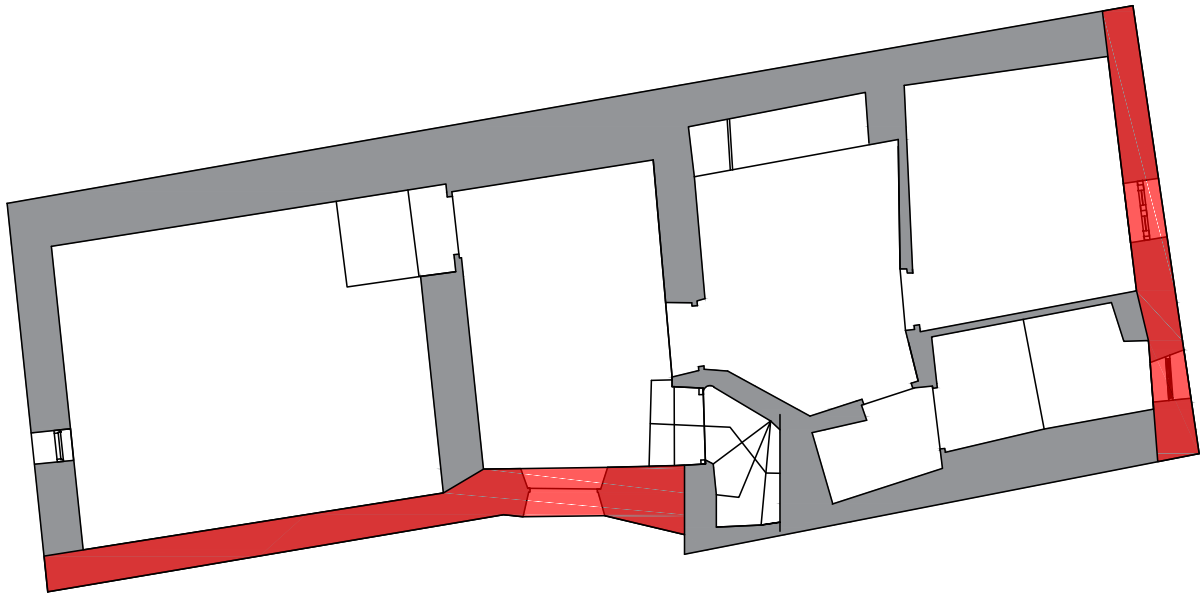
Fisuras en fachada Norte. Fuente propia.
